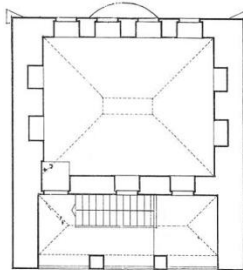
مسقط أفقي لكلية قاضي أغاسي محمود آغا وما بها من مكتب صبيان - نقلاً عن :
